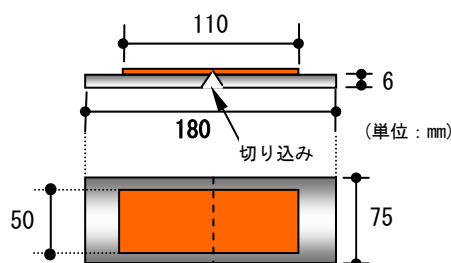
ひび割れ追従性試験における試験体の形状 Shape of the Specimens
